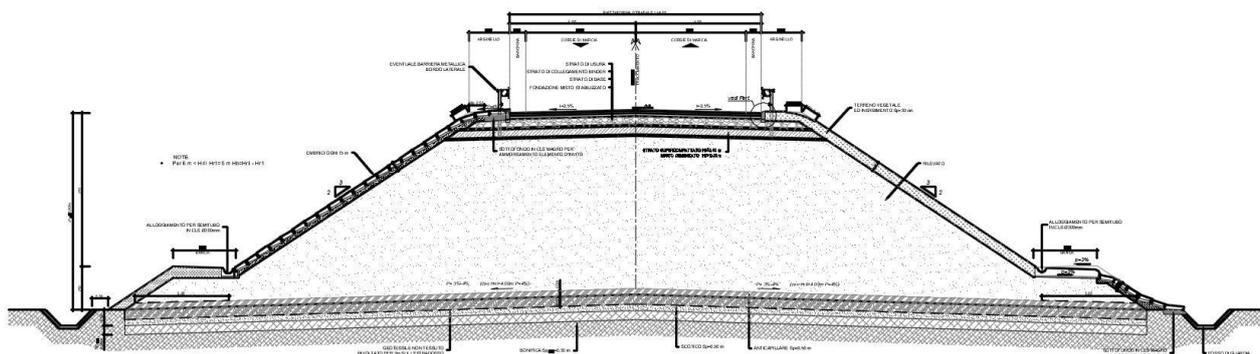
sezione tipo strada 8.00m in rilevato $H_{ril} > 6.00 m$
